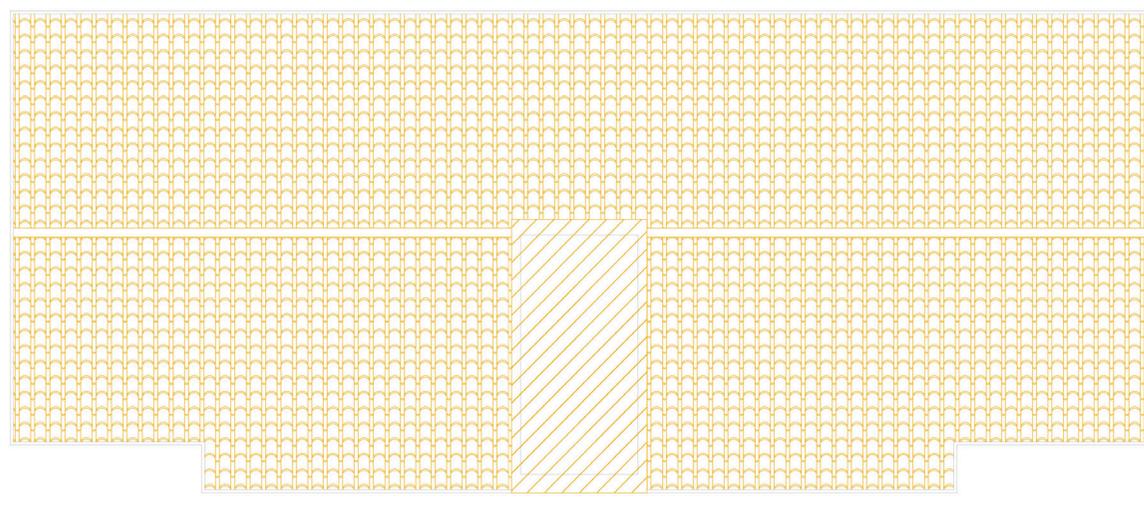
Plano Cubierta. Fuente: Elaboración propia.
